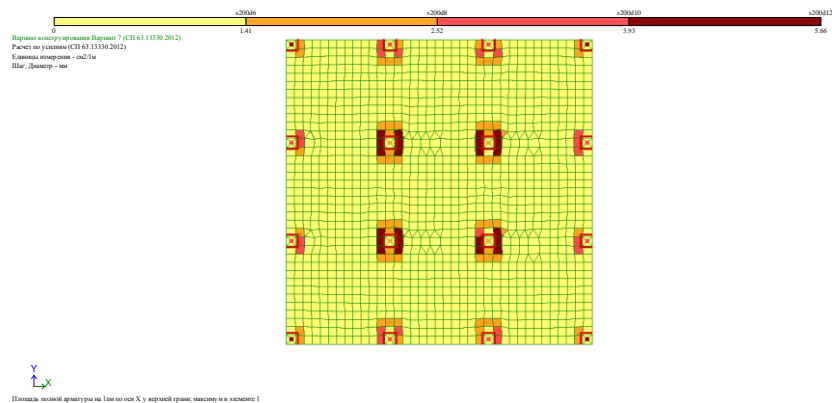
Подбор верхней продольной арматуры плиты
